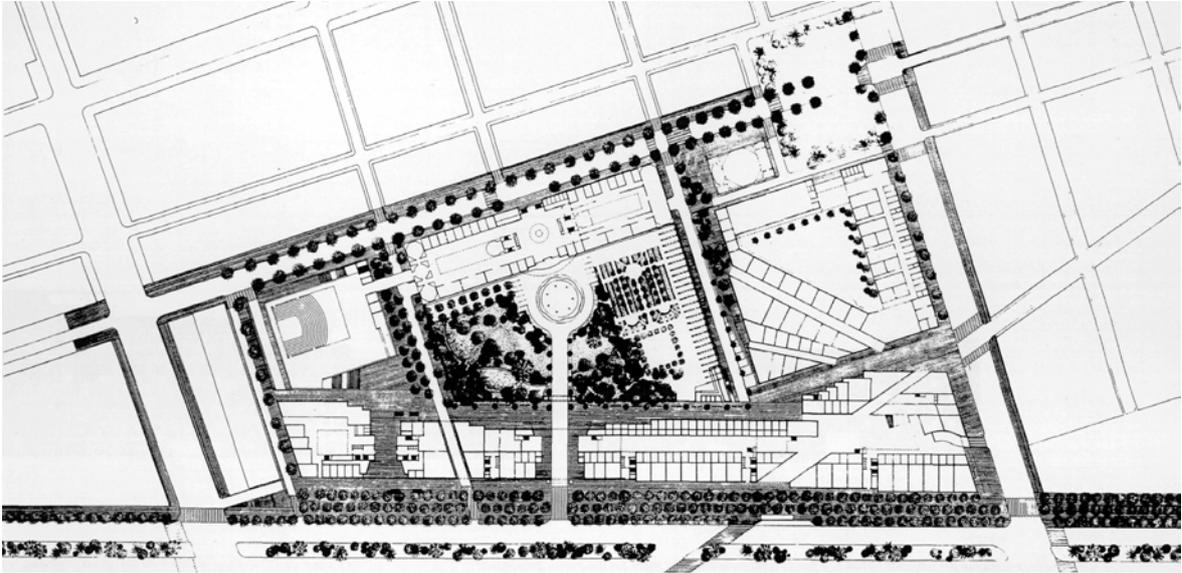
Planta baja, concurso internacional de ideas L'illa Diagonal.
